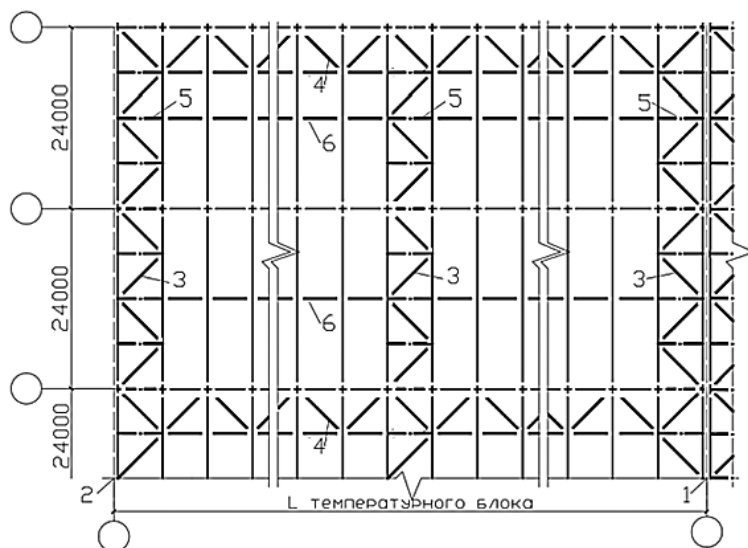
Фрагмент схемы расположения связей 1-го типа по нижним поясам стропильных ферм пролётом 24 м и шагом 6 м:
